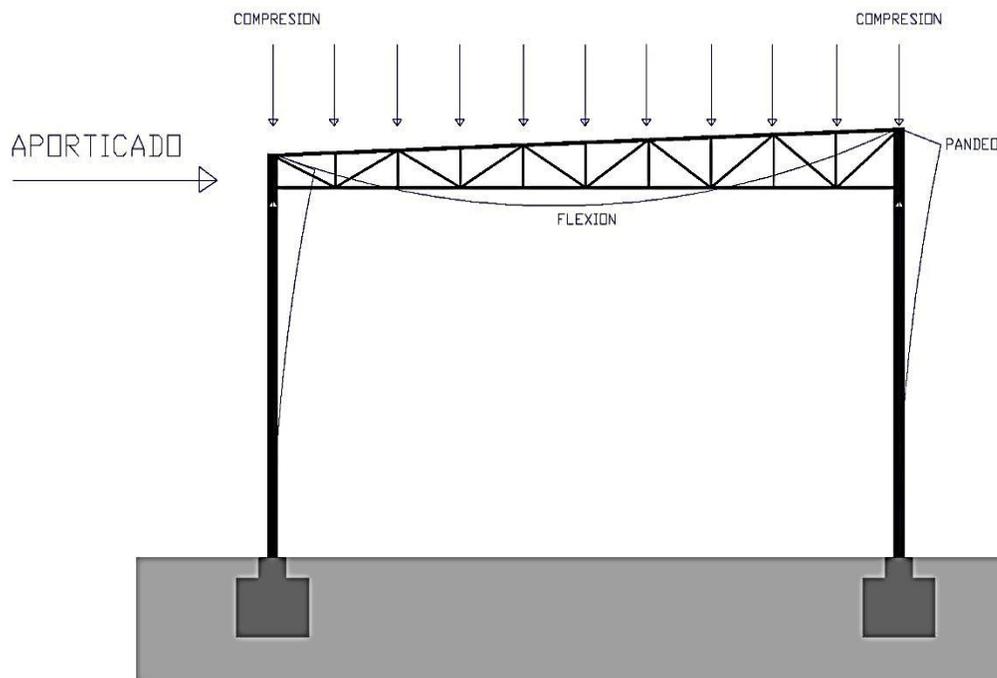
Esquema comportamiento estructural Aporticado
